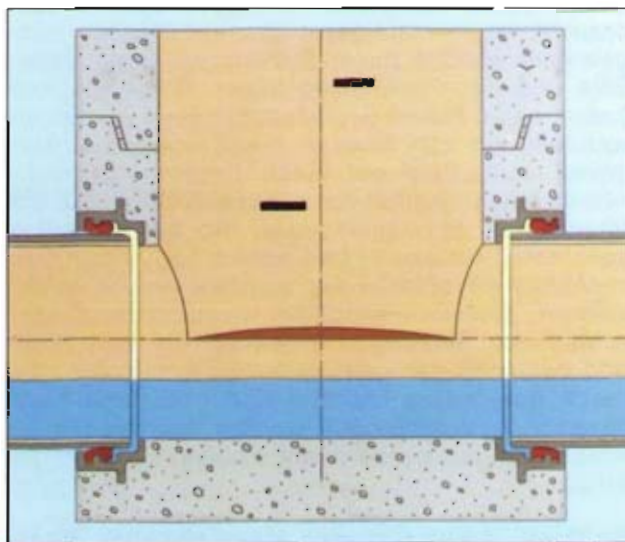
Schachtanschluß als Steckmuffen-Verbindung nach DIN 28 603
